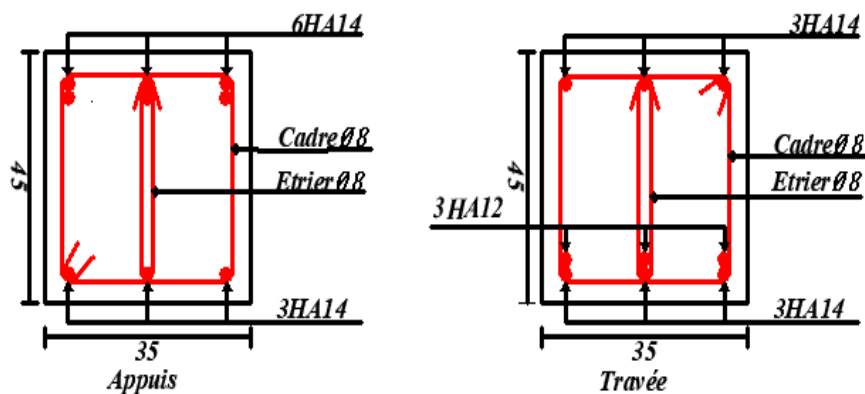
Schéma de ferrailage de la poutre principale du plancher commerce
